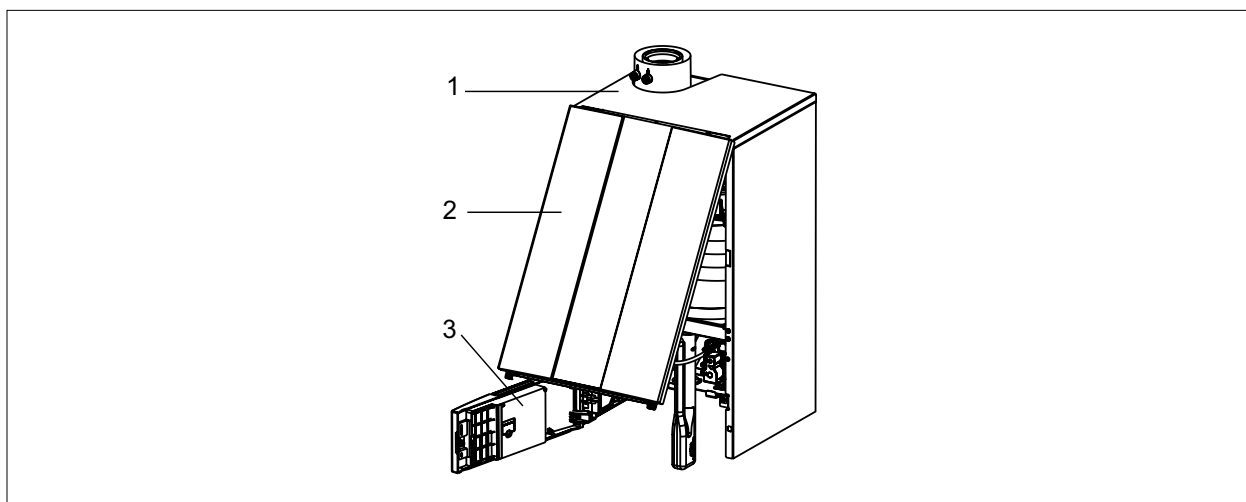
Montar la tapa del equipo y el revestimiento frontal
